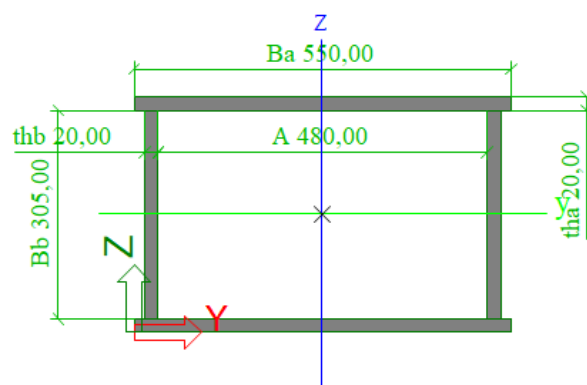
Modellering diagonale pijlers - SCIA Engineer
